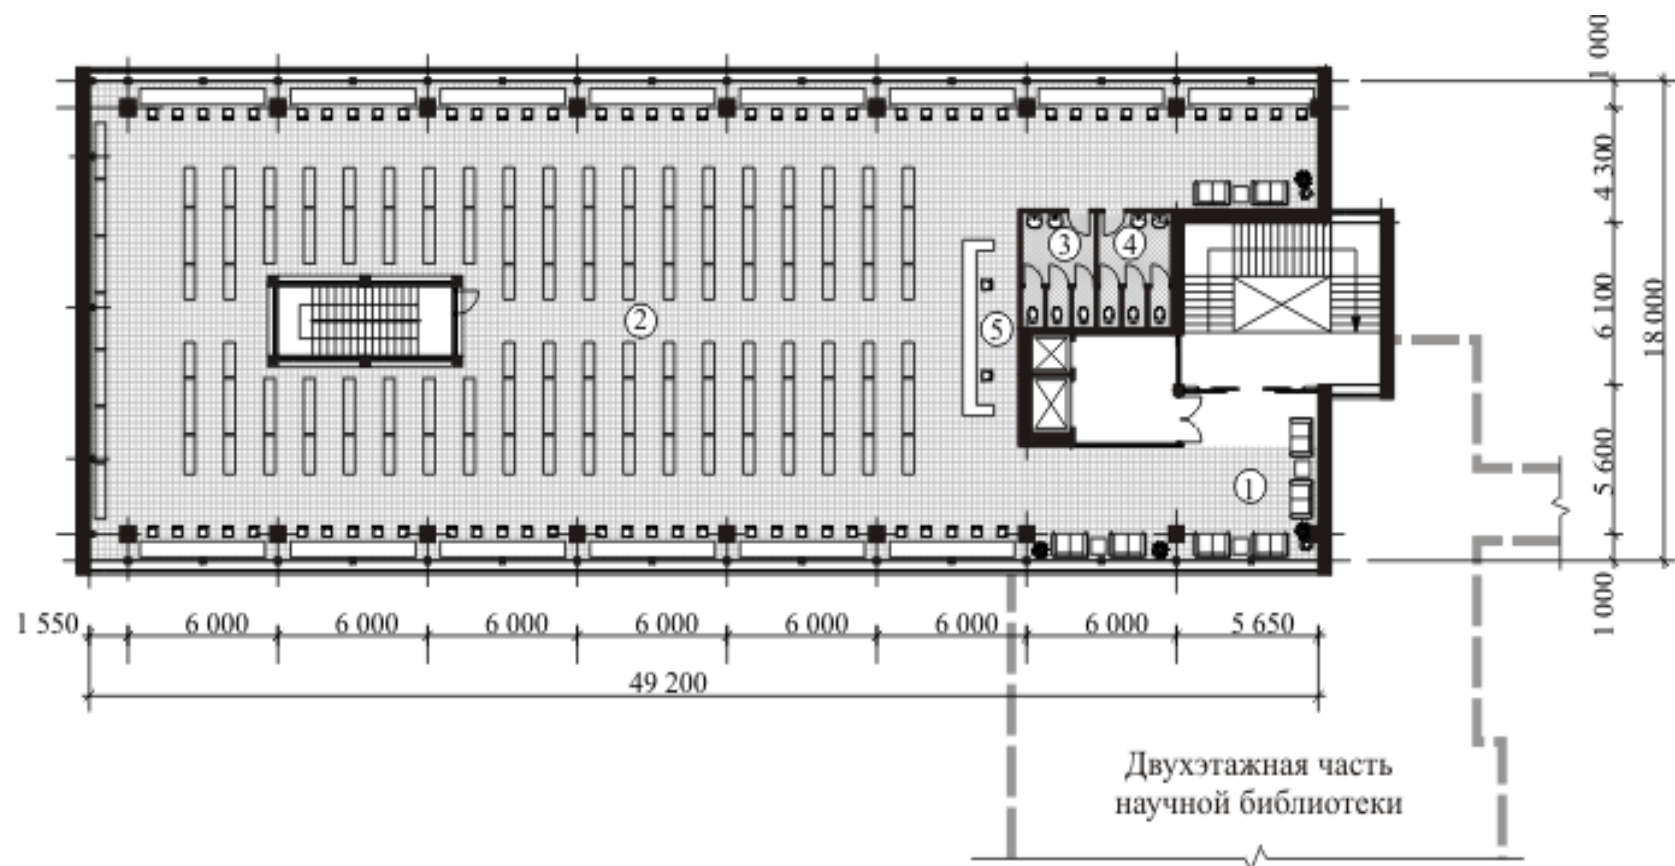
План третьего этажа проектируемой научной библиотеки: 1 – фойе; 2 – книгохранилище открытого доступа; 3, 4 – санузлы; 5 – рабочее место обслуживающего персонала
